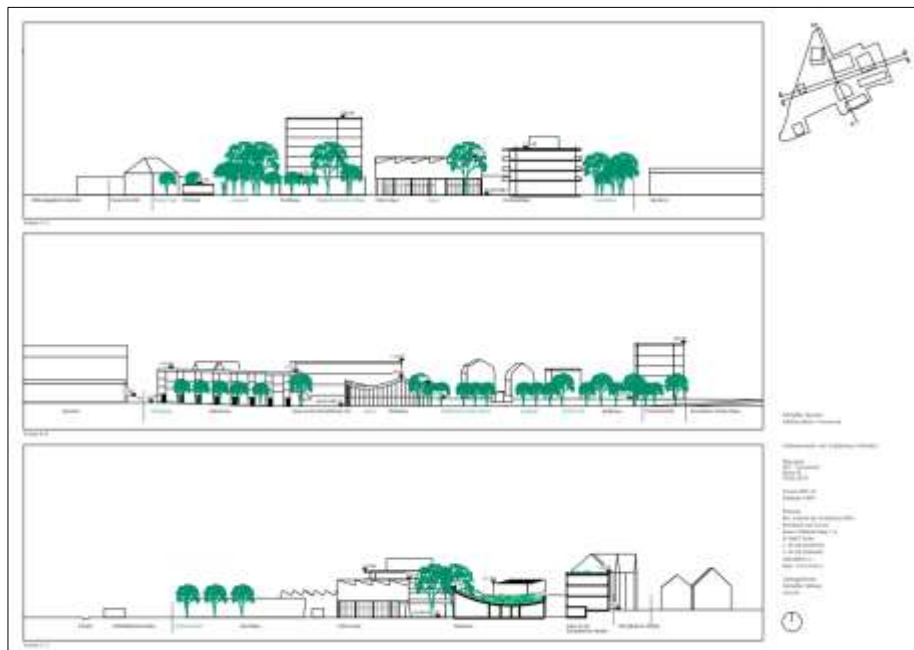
Geländeschnitte mit Testplanung Gebäuden, 30.06.2023 Planung BeL Sozietät für Architektur BDA
